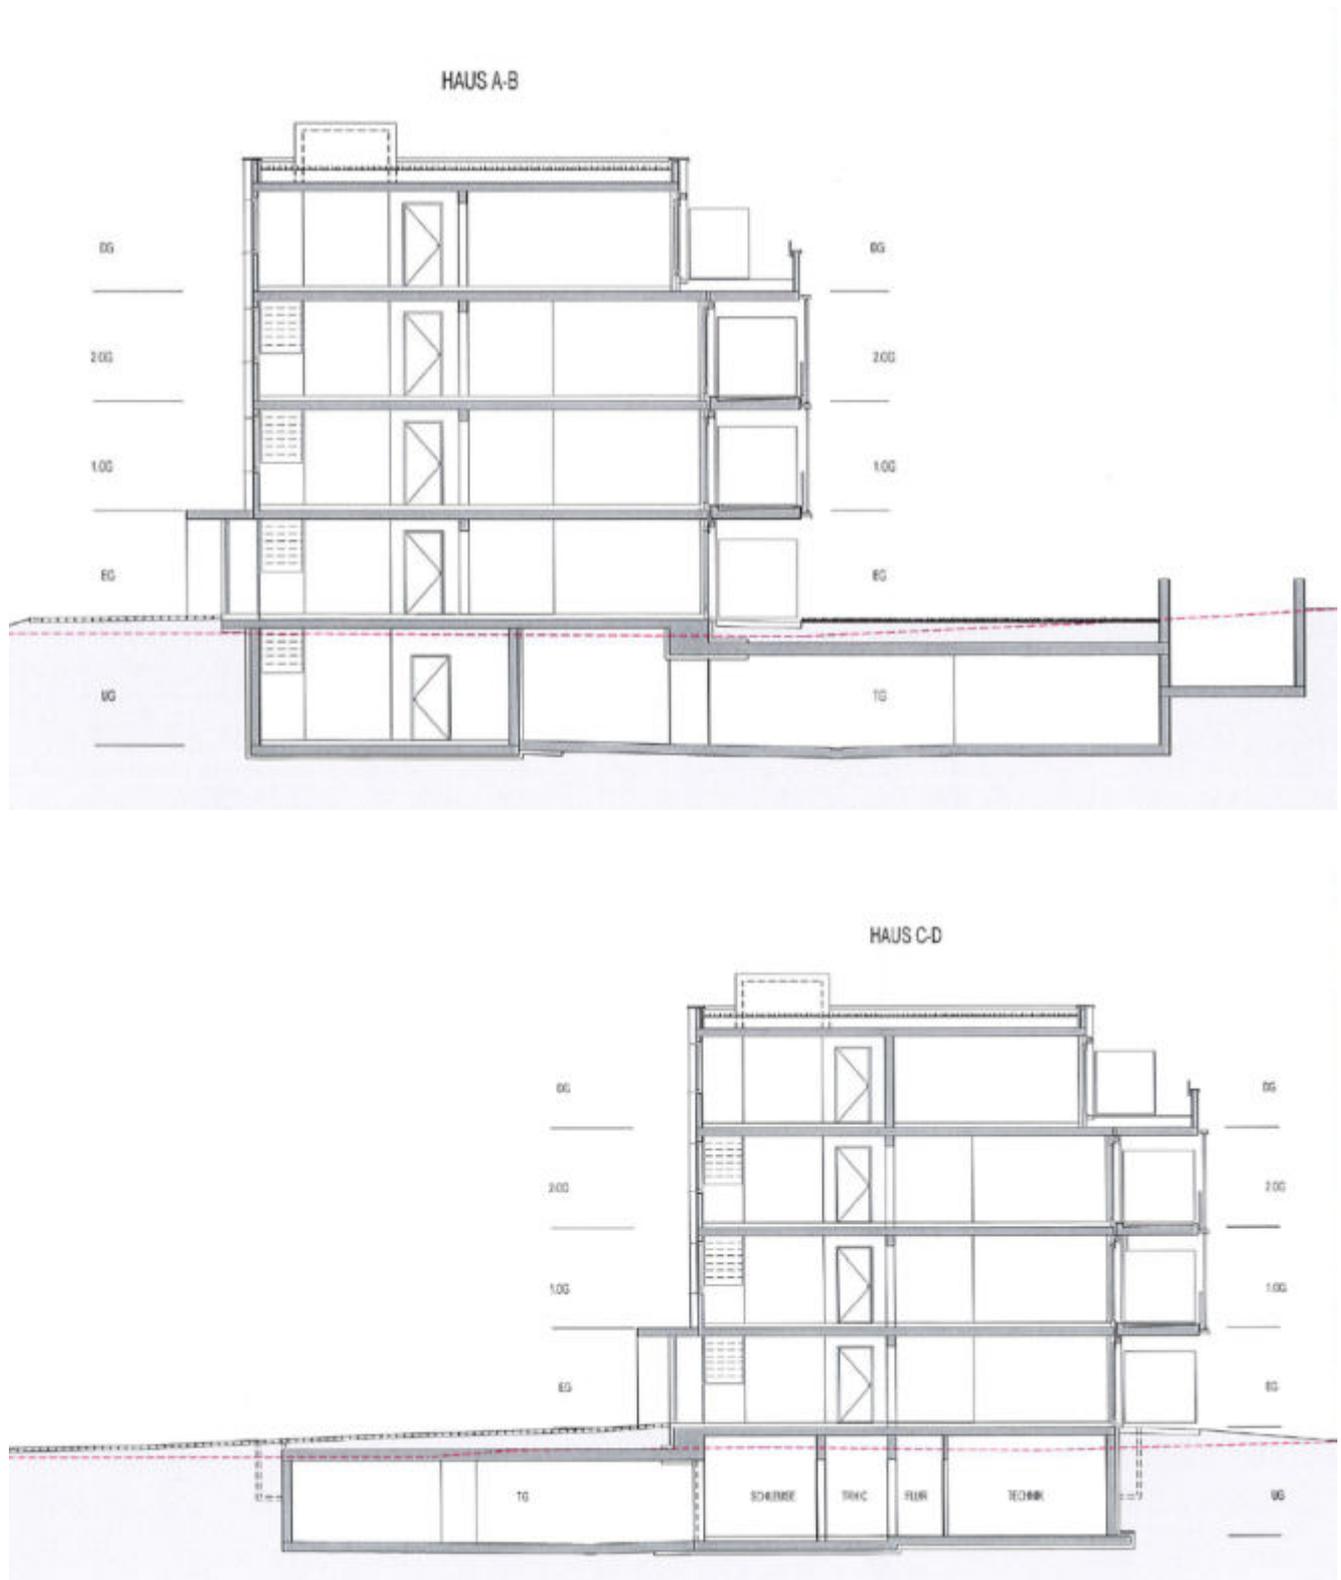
Gebäudeschnitte Haus A-B (oben) und Haus C-D (unten); Quelle: Anlage 1 zur Urkunde 303/2021/ Teilungserklärung vom 10.02.2021,
